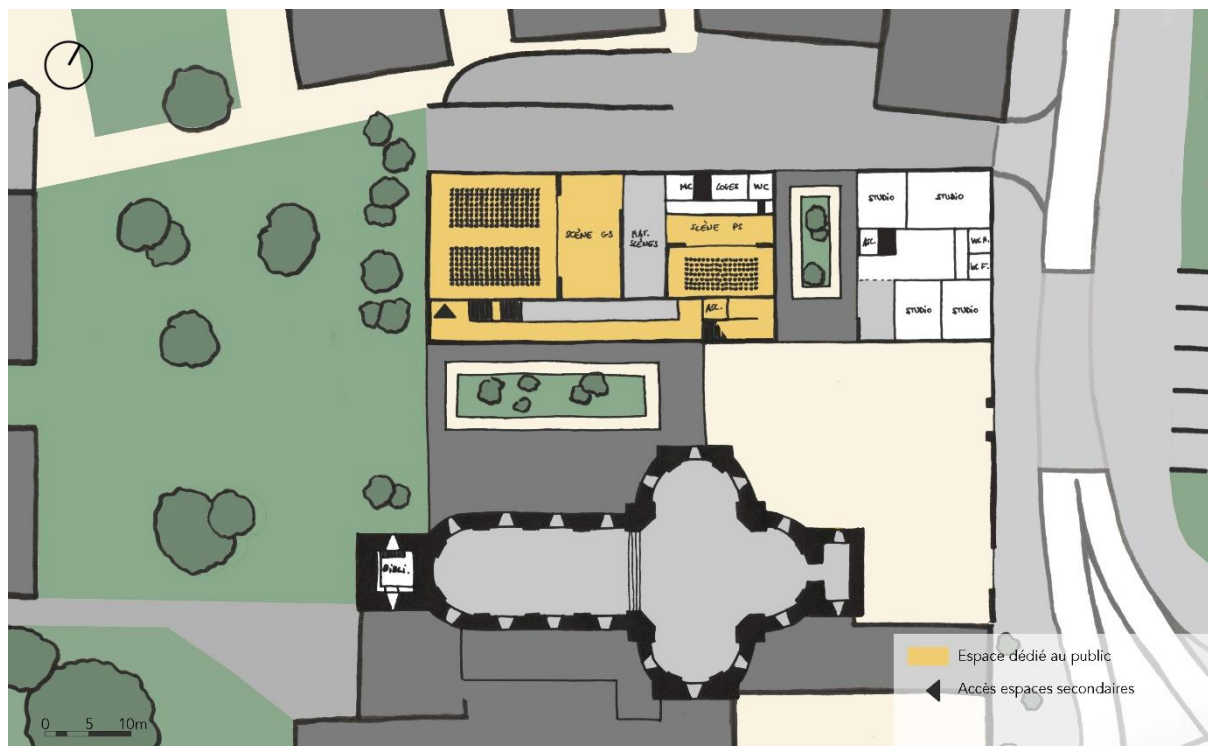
Distribution des accès possibles durant le cheminement du public (fond de plan WalOnMap, 2016)
